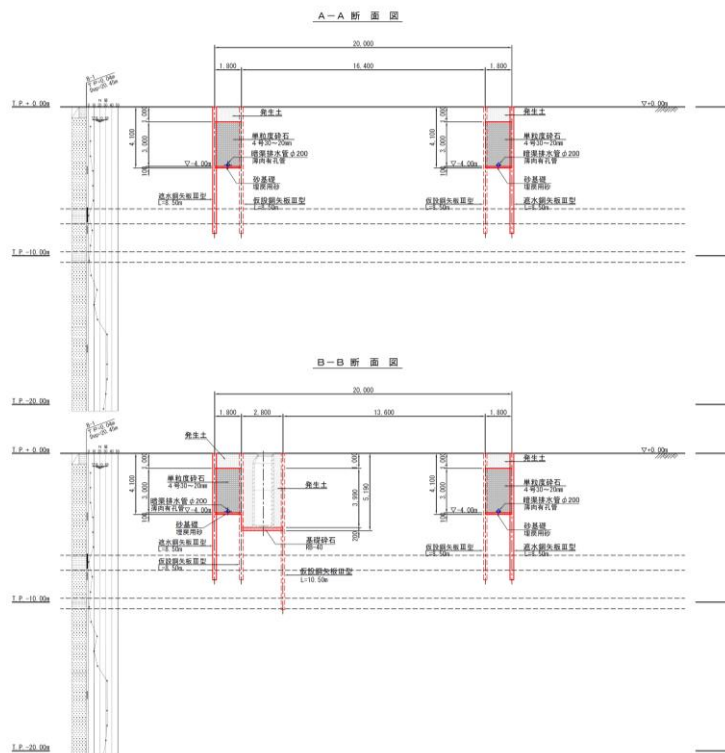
試験施工エリアの標準断面図（六角地区）
